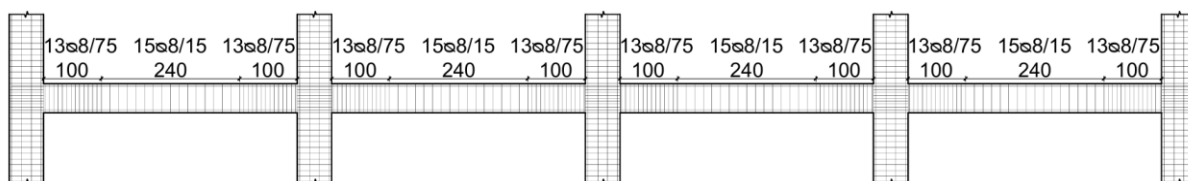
Rappresentazione dell'armatura trasversale all'interno degli elementi strutturali della seconda configurazione (quote espresse in cm)
